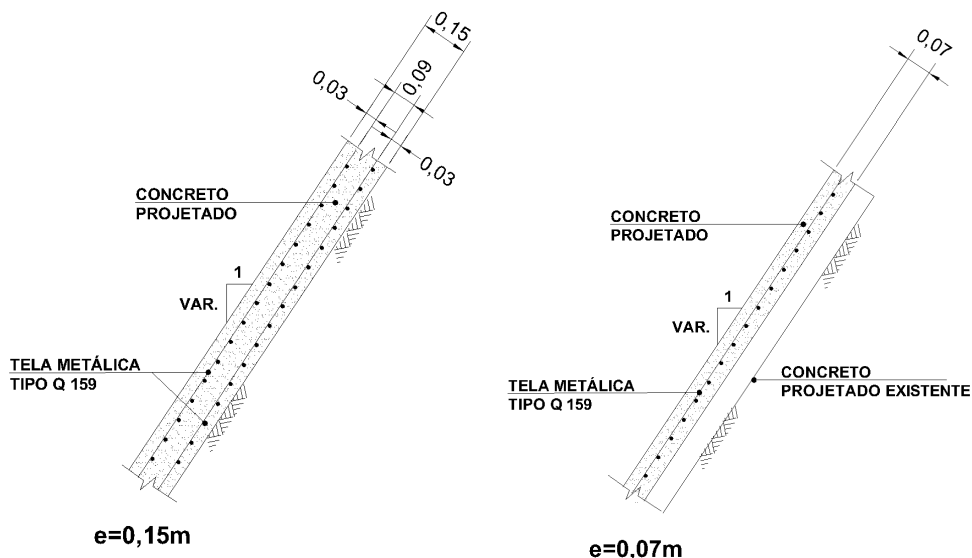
Detalhe de corte do Paramento em Concreto Projetado, armado com tela
